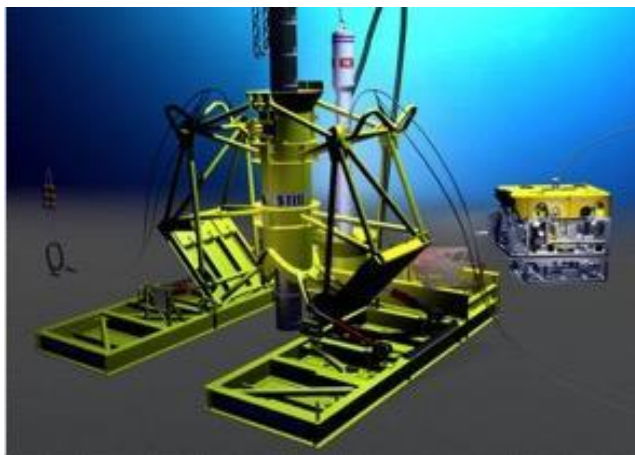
sistema di infissione di un palo nel fondale marino
